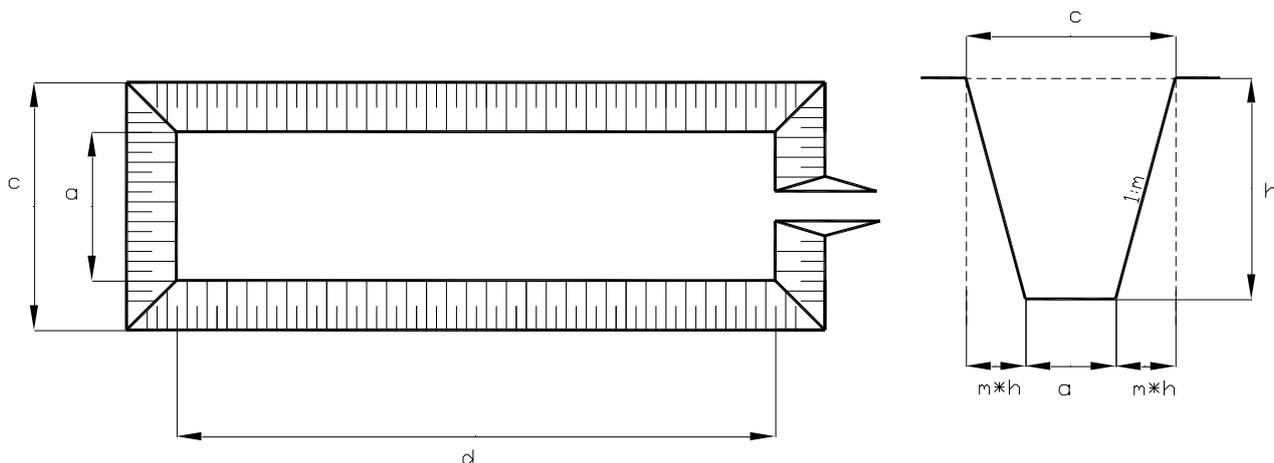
Расчетная схема к определению объема грунта в котловане (траншеи)
